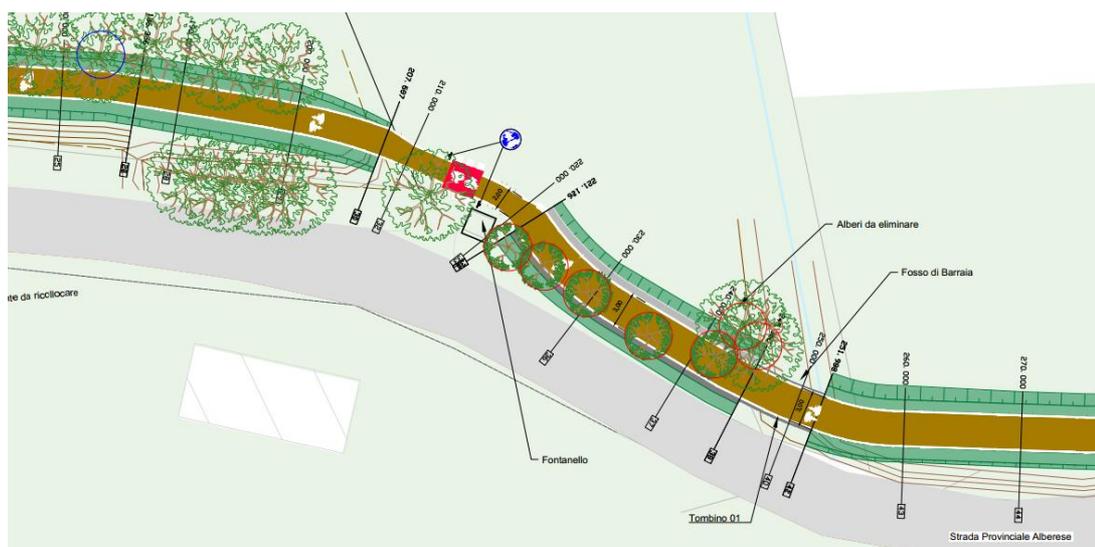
Estratto Planimetria di Progetto - Fontanello
